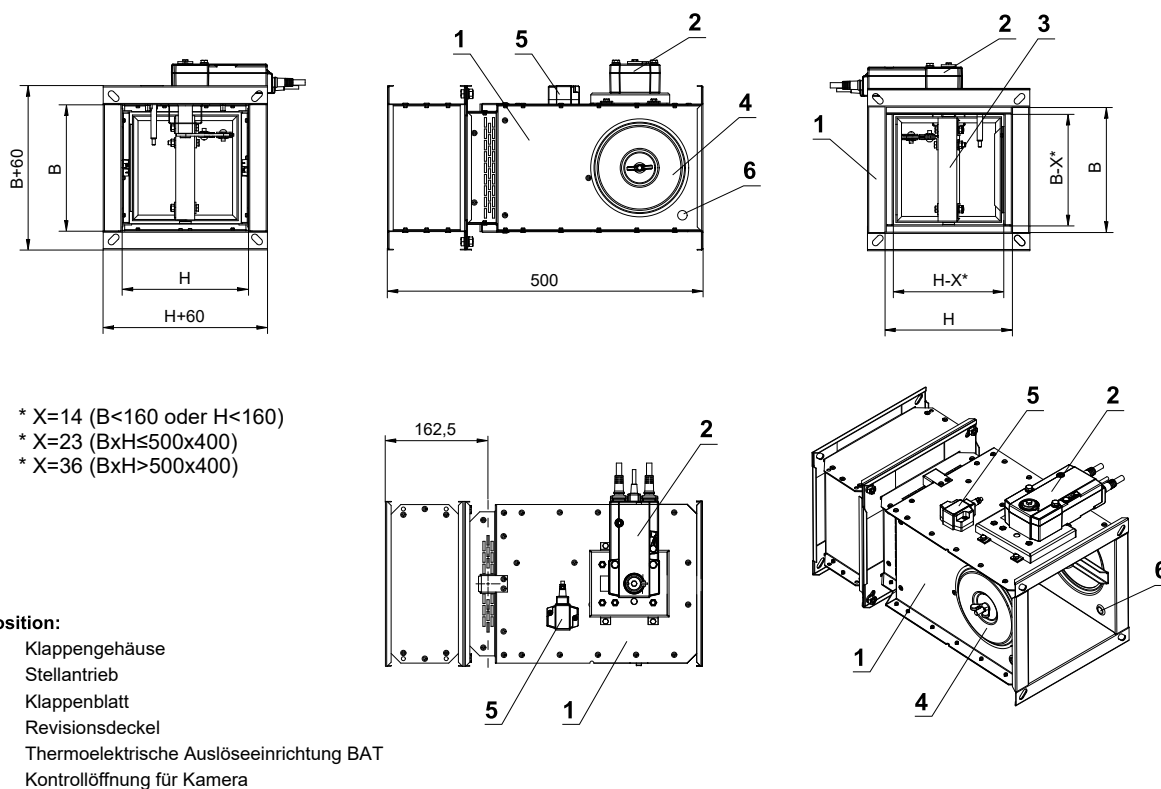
AUSFÜHRUNG MIT STELLANTRIEB
